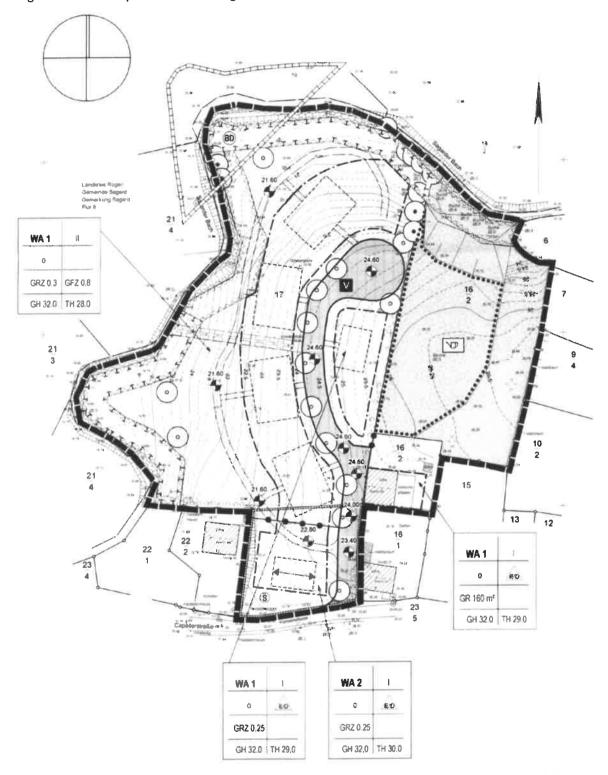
Ursprungsplan, Planzeichnung ohne Maßstab
